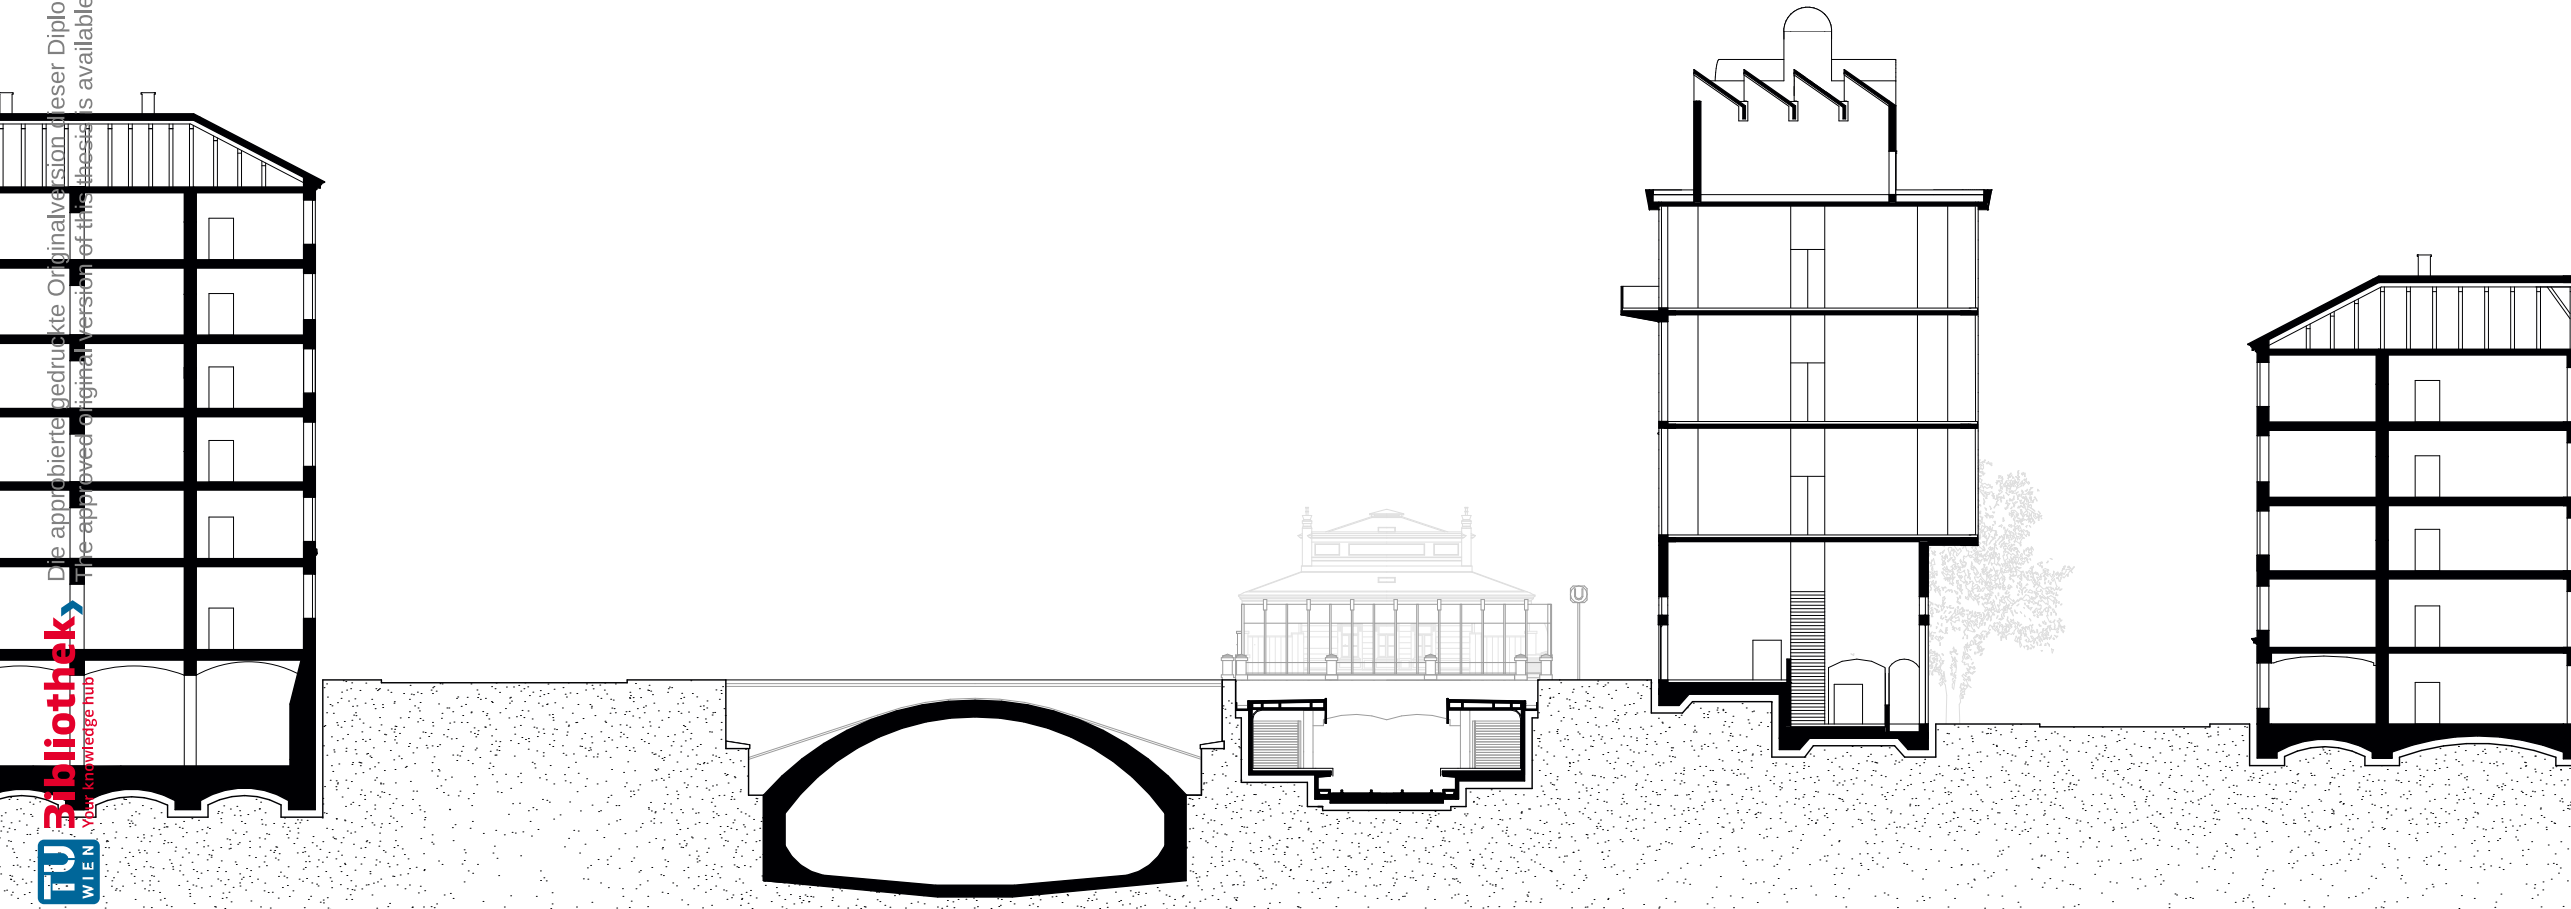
/ Schnitt "1-1" M 1:400 (Plan erstellt von PB) <
